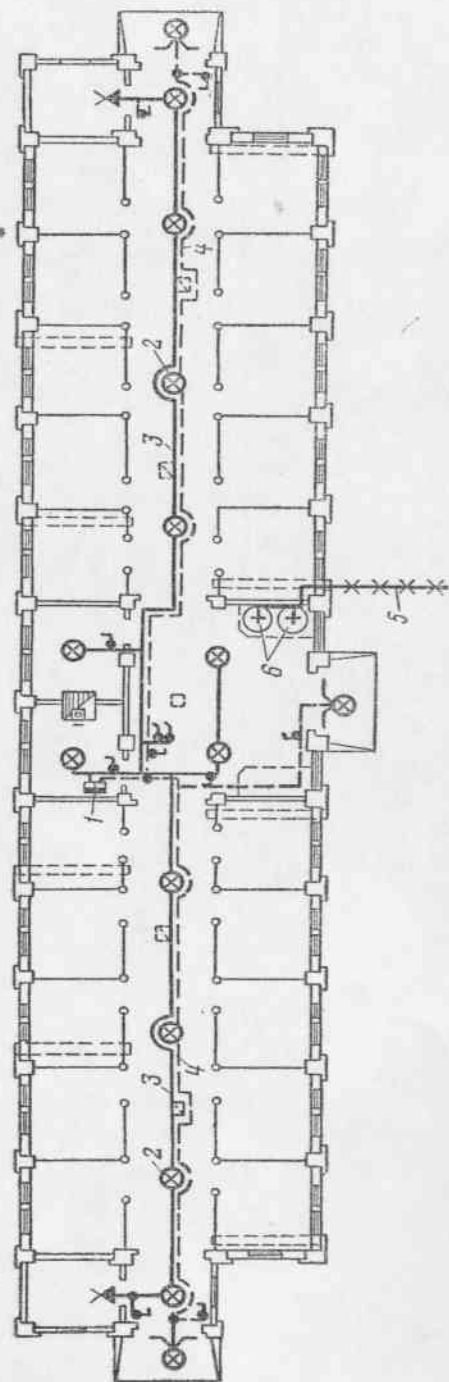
План конюшни на 20 голов тренировочного молодняка со схемами сетей электроосвещения и водопровода: 1—групповой щиток; 2—арматура фарфоровая полугерметическая; 3—сеть рабочего освещения; 4—сеть дежурного освещения 5—ввод от наружного водопровода; 6—бочки для воды.
